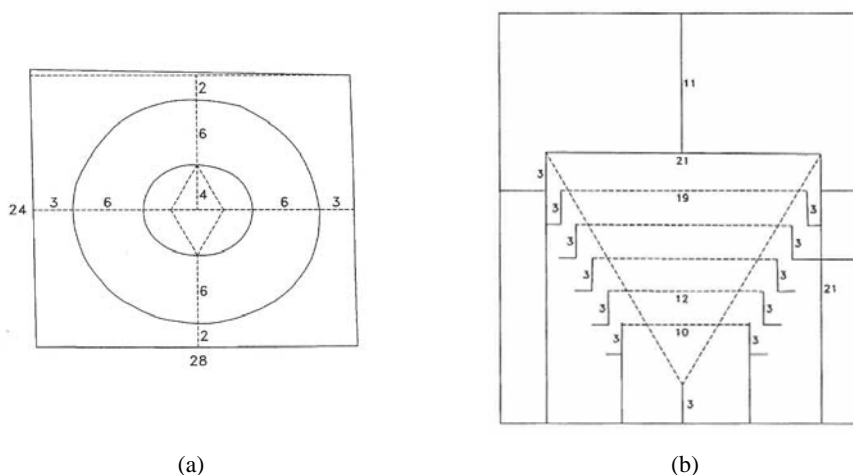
Schema delle dimensioni in piedi Padovani della sezione trasversa (a) e longitudinale (b).
